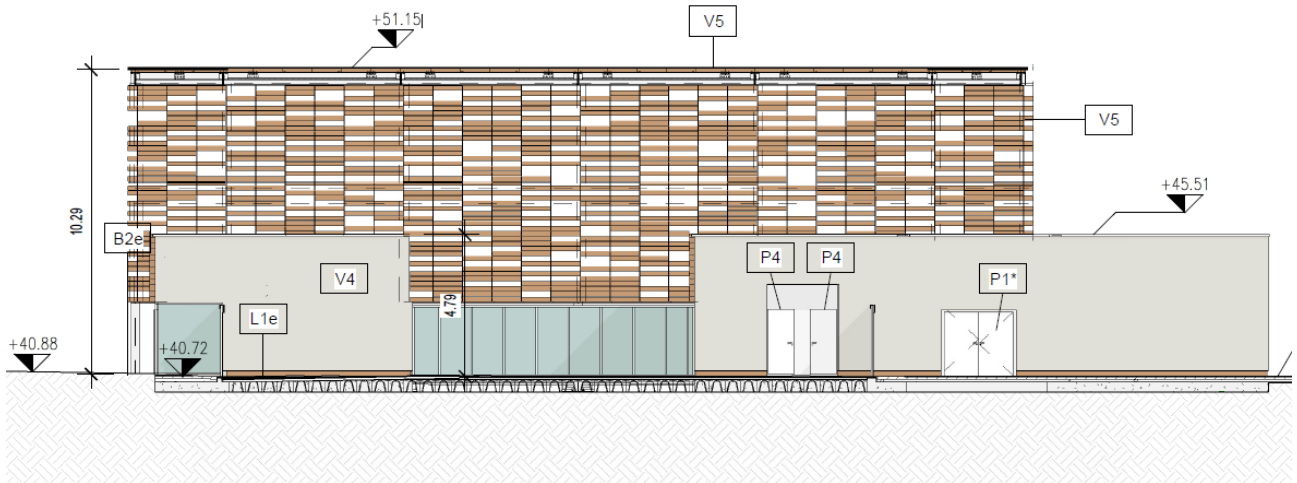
FV05 - Pensilina FV – prospetto retrostante
